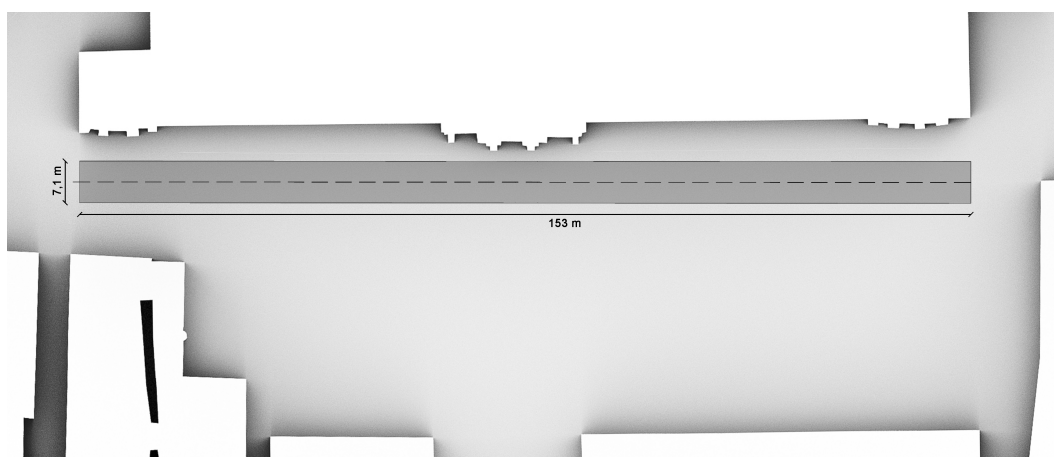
Schema indicativo del tratto di strada soggetto ad intervento
